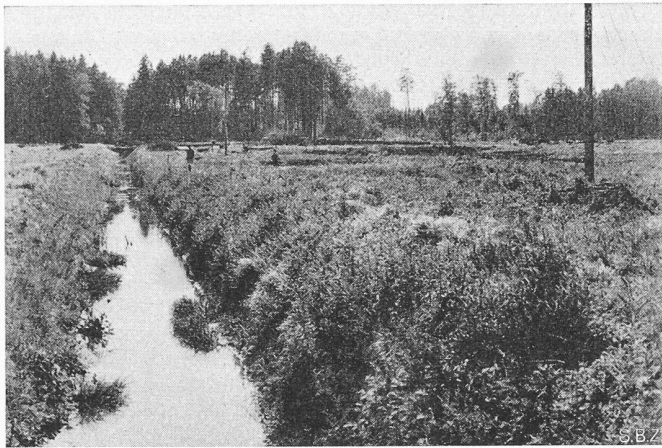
Ursprüngliches Flughafengelände am ehemaligen Himmelbach, mit teilweisem Waldschlag (Photo Brügger, ETH)
